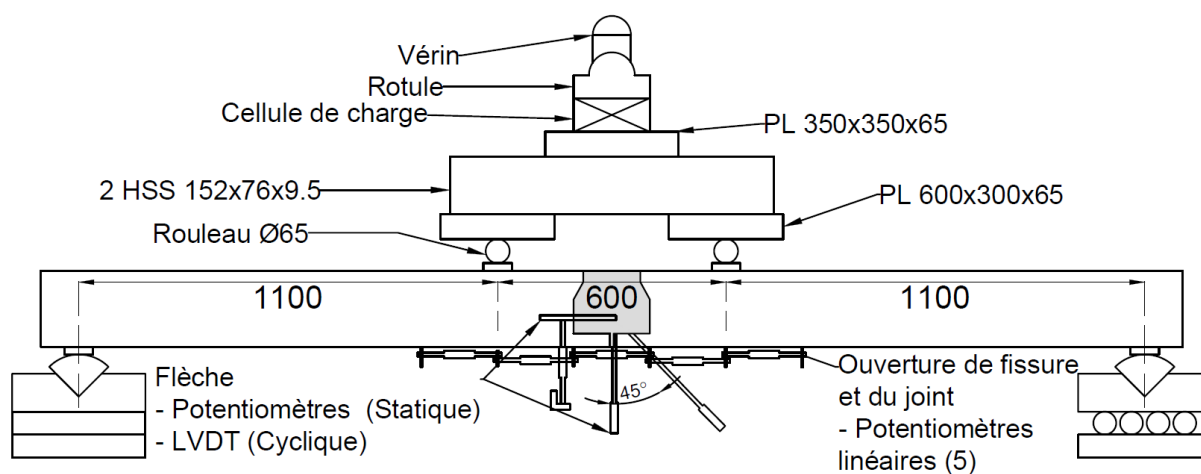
Plan du montage en laboratoire – Dalle avec joint de connexion longitudinal
